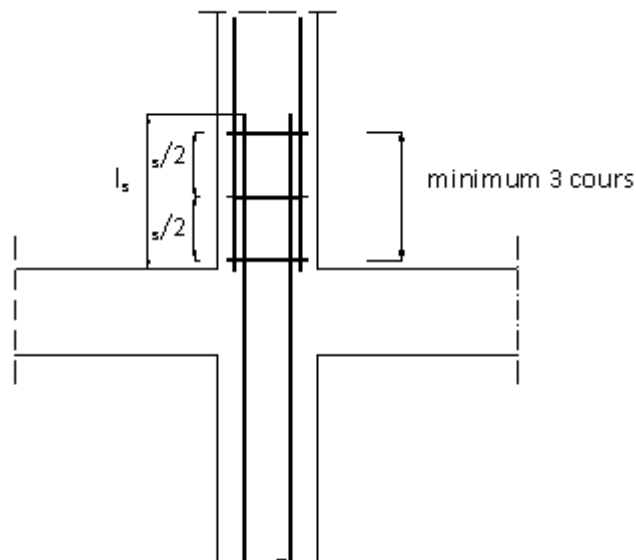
Les armatures transversales dans la zone de recouvrement
